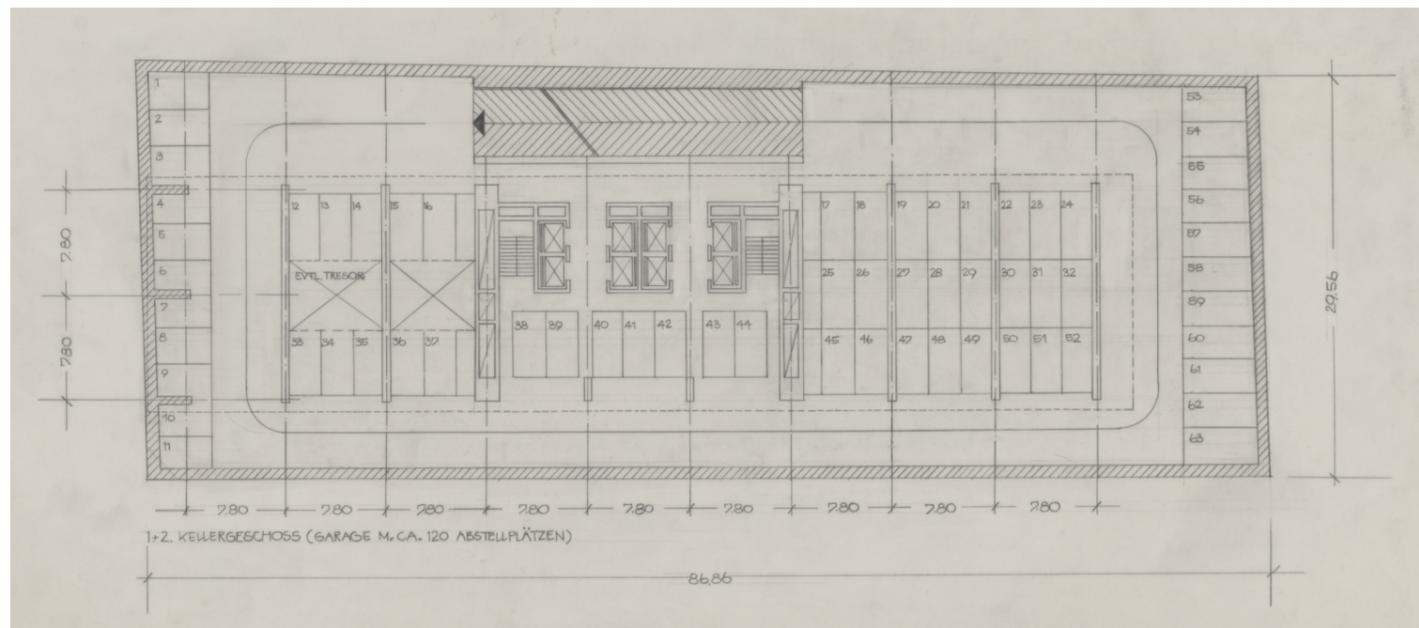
1./2. Kellergeschoss (Grundriss), 1:200, 17.1.1961
